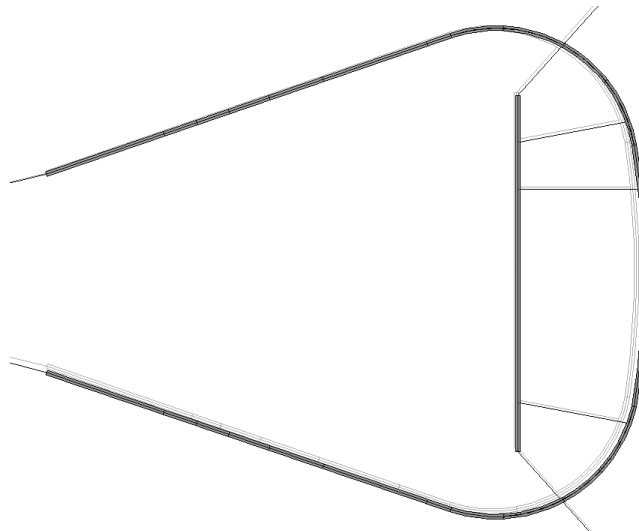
Sobreposição das paredes estruturais do modelos de projeto e por nuvem de pontos em planta. Fonte: Autor.
